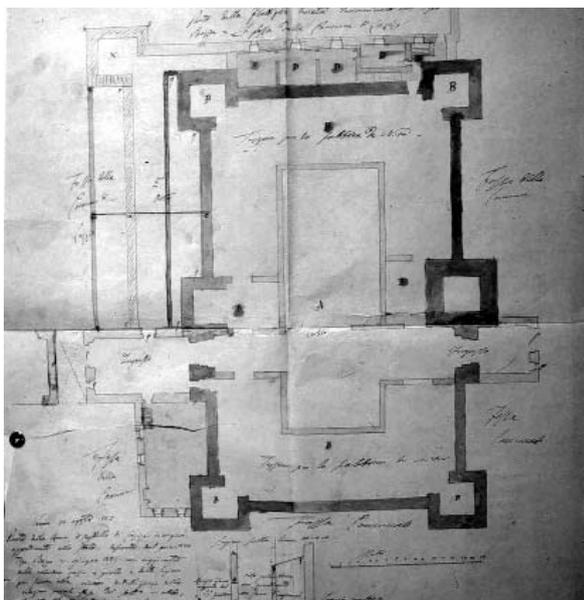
Metà XIX sec ca. Planimetria di Lazise e le sue mura. Kriegsarchiv, Wien.
